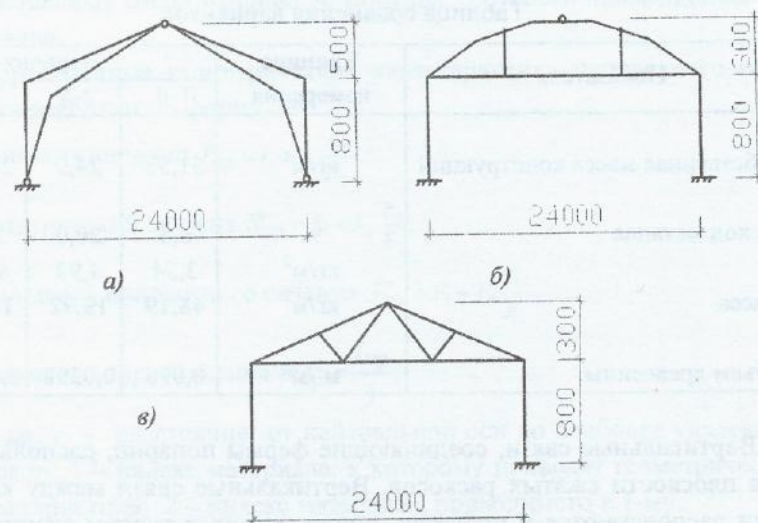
Варианты несущих конструкций: а – клееная рама из прямолинейных элементов; б – трехшарнирная арка кругового очертания; в – металлодеревянная ферма
